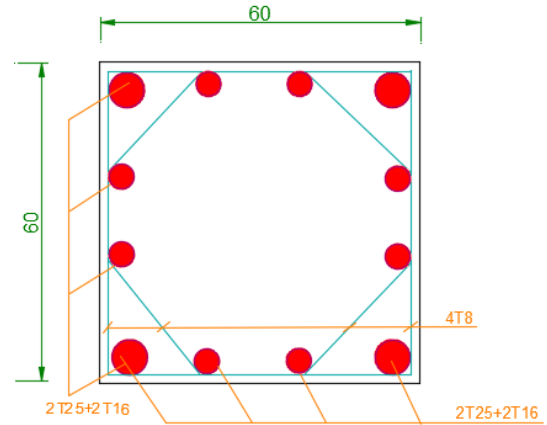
Schéma De Ferrailage Des Poteaux de 5^{eme} étage.
